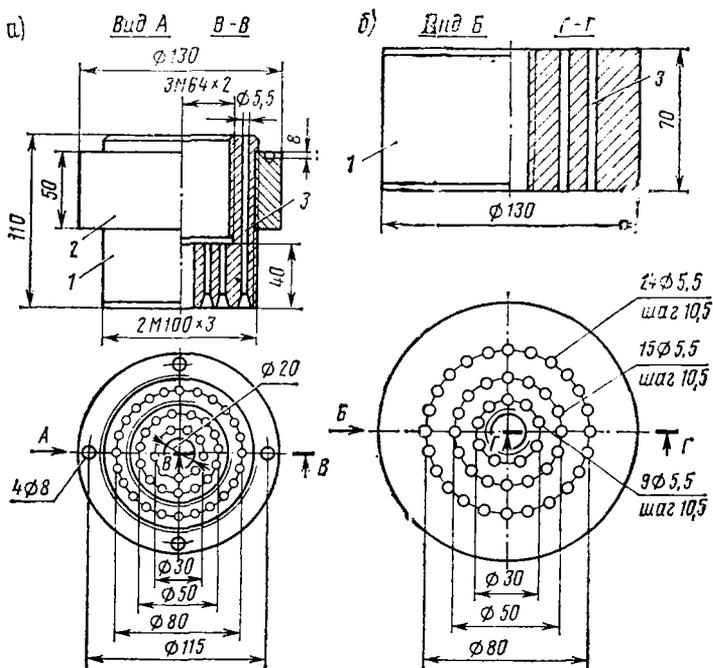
Натяжной и неподвижный анкеры типа Т48М для 48 проволок: 1 — стальной цилиндр; 2 — гайка; 3 — отверстие для проволоки
